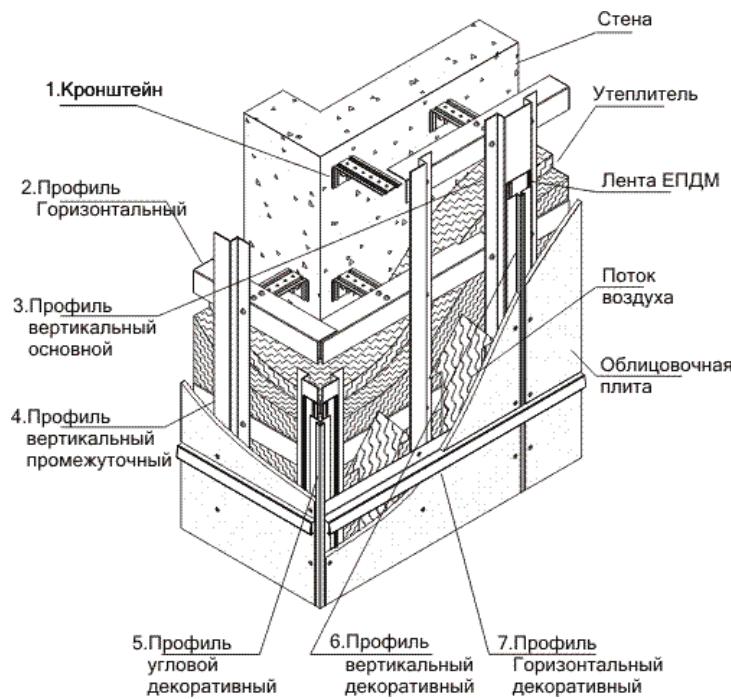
Конструкция навесної фасадної системи с вентилируемым воздушным зазором.
